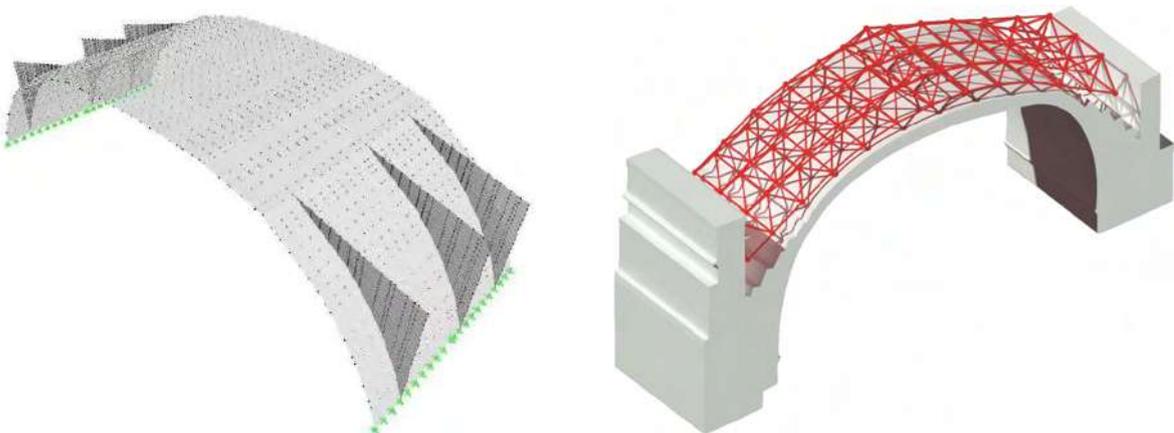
, 9 – La modellizzazione a elementi finiti e lo schema del telaio reticolare di consolidamento.
